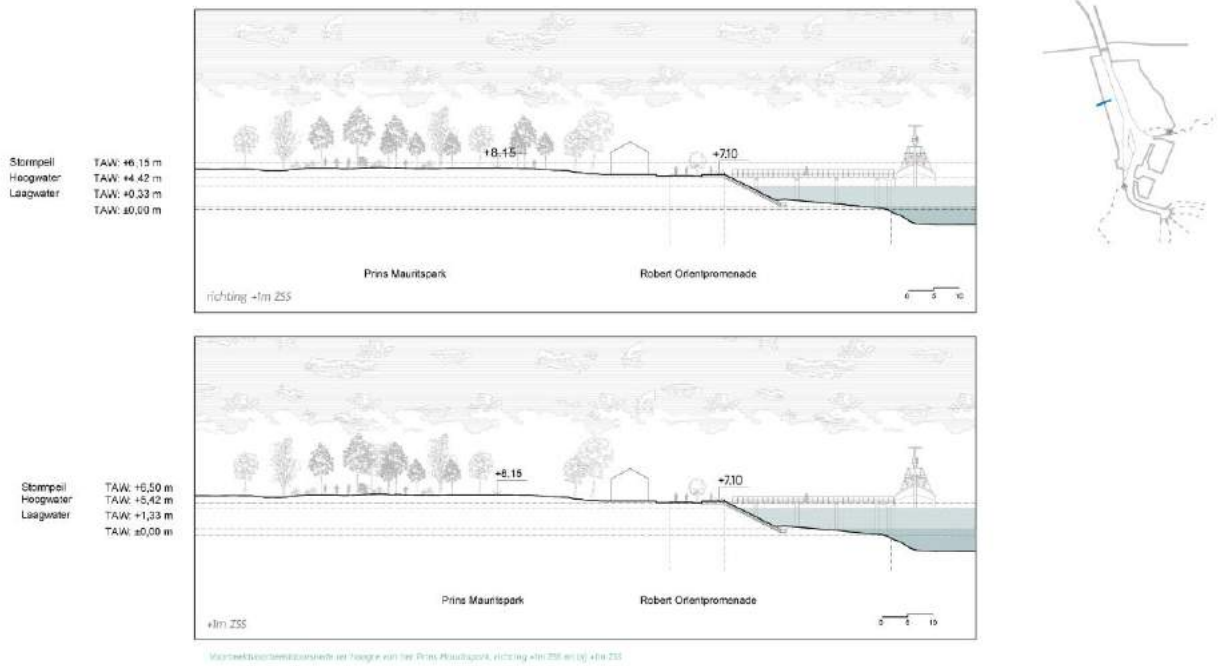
| Voorbeelduitwerking Prins Mauritspark bij -1m ZSS en 0m ZSS | Voorbeeld uitwerking
